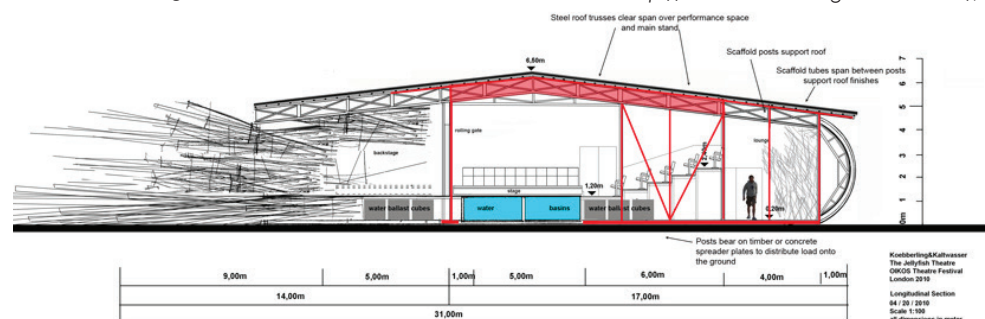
Sezione longitudinale; Fonte: <http://www.koebberlingkaltwasser.de/>;
